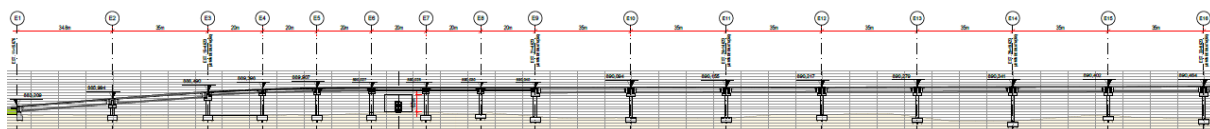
ELEVÇÃO VIADUTO (EIXOS E1 AO E16)
